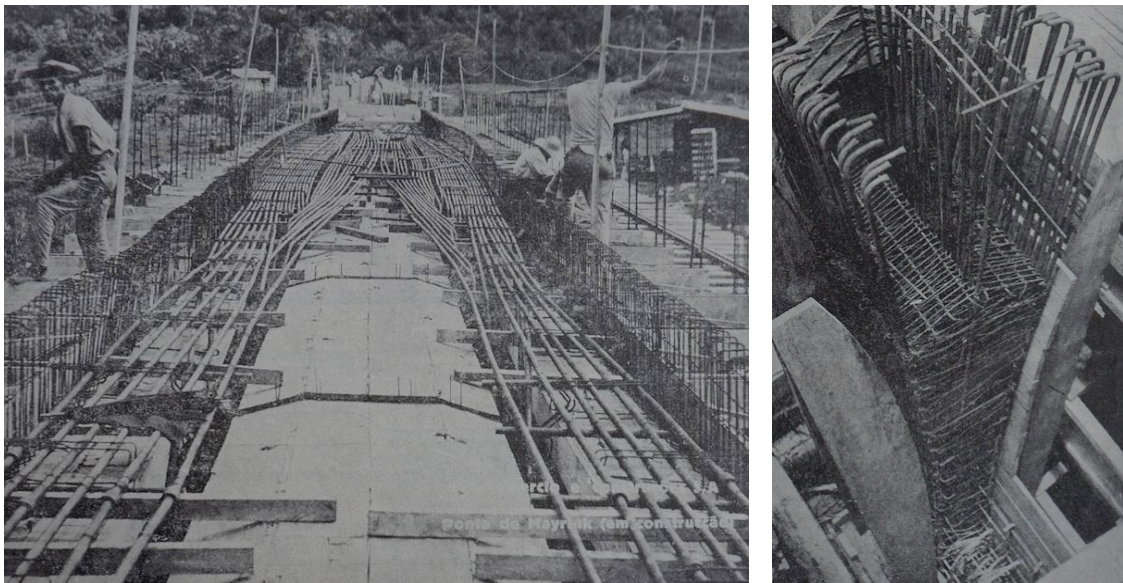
Esq. Fase de execução da ponte. Dir. Detalhe de uma articulação. Os ferros centrais formam a articulação para a carga fixa. Os ferros laterais são concretados depois e servem para enrijecer a ligação. FONTE: CONCRETO, 1939.
